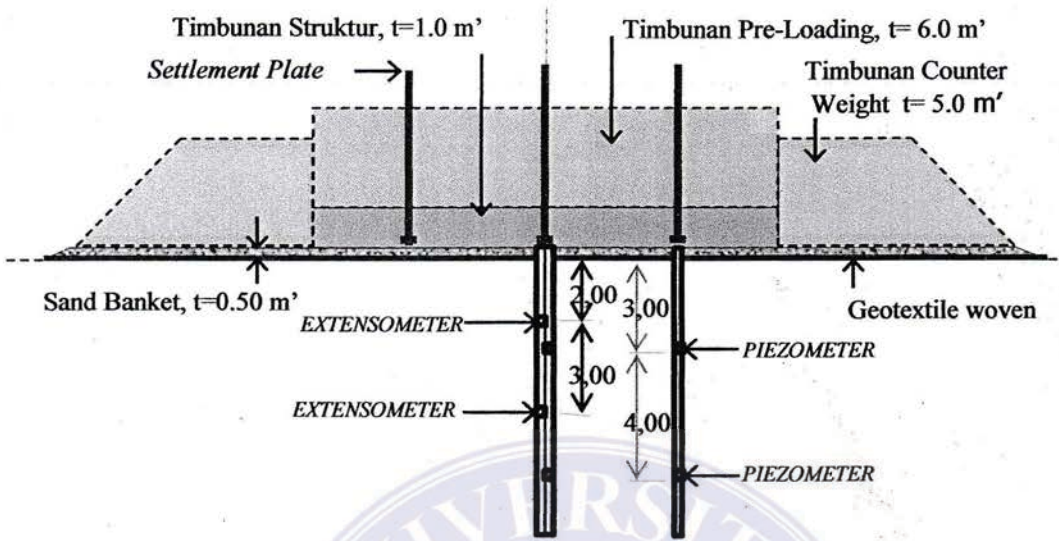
Penampang Timbunan Preloading dan Counter Weight
